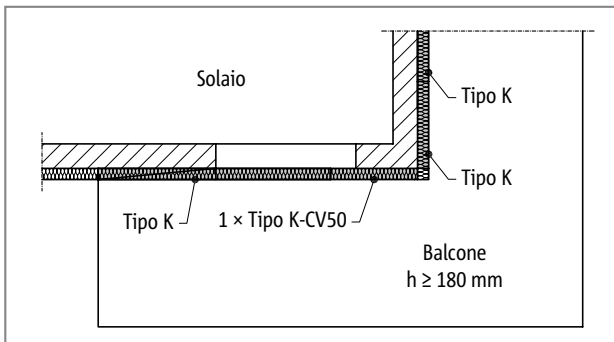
Schöck Isokorb® tipo K, balconi ad angolo esterno
